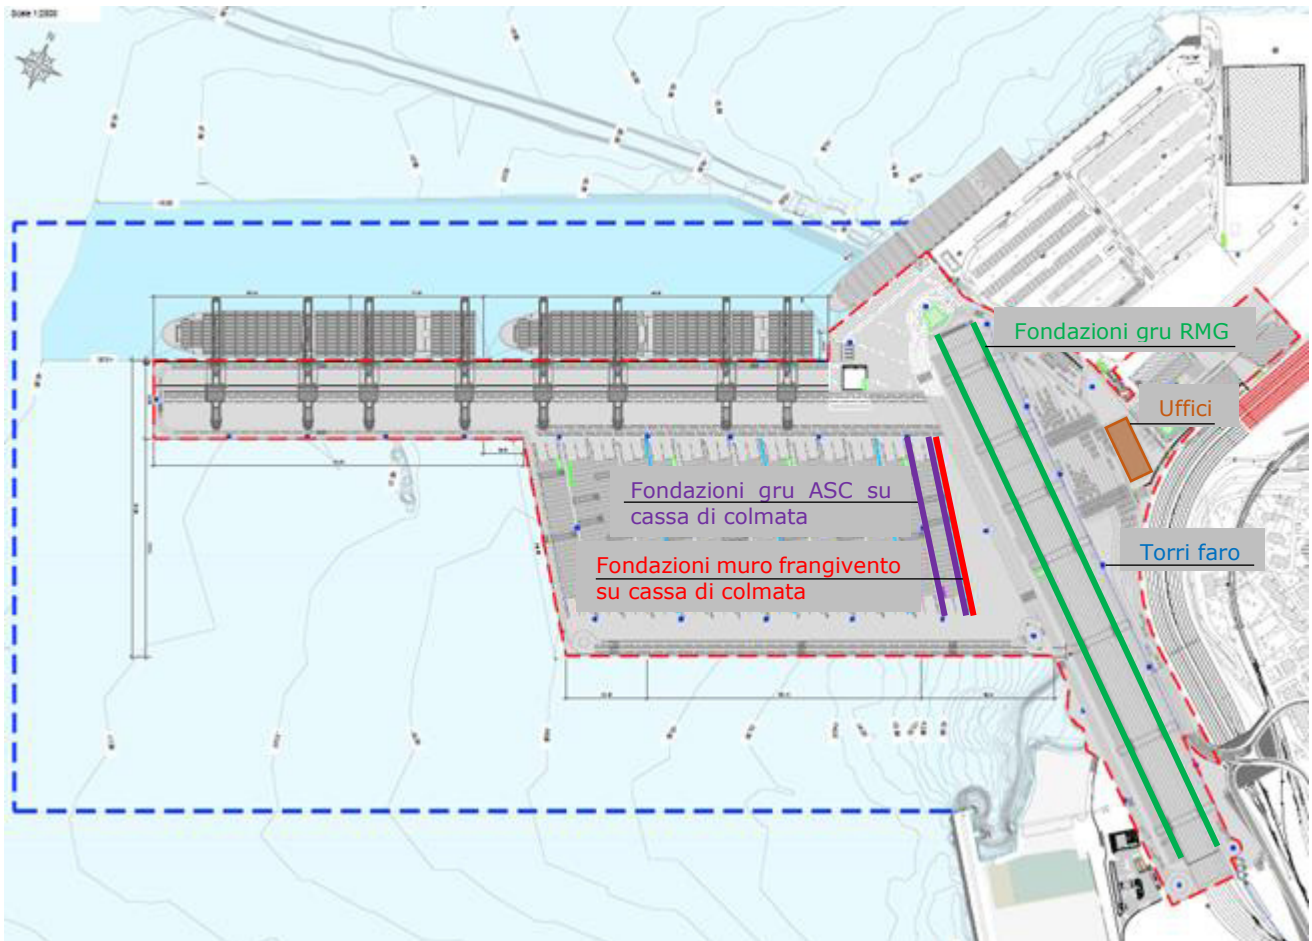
Planimetria di progetto con indicazione delle fondazioni a terra
